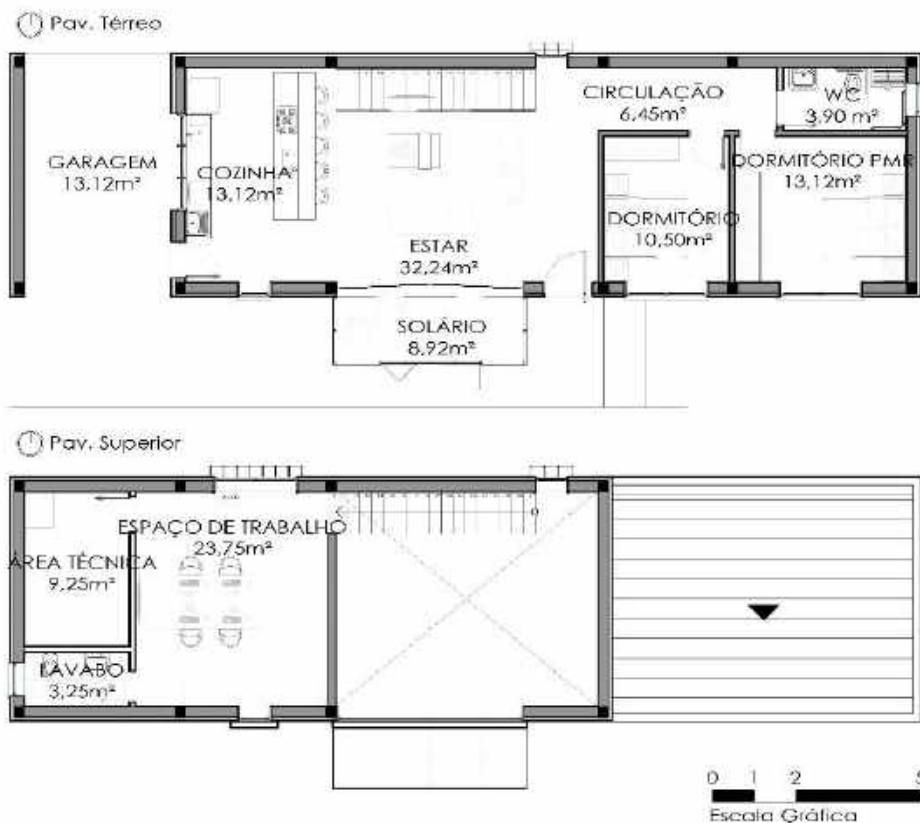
Planta baixa térreo e segundo pavimento, para a orientação Sul. Adaptado de Dalbem, 2015.
